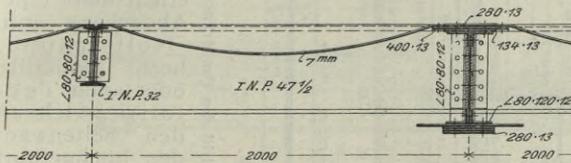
Mittlerer Längsträger der Unterführung der Berlin-Brandenburger Chaussee. (Zu Abb. 178).
